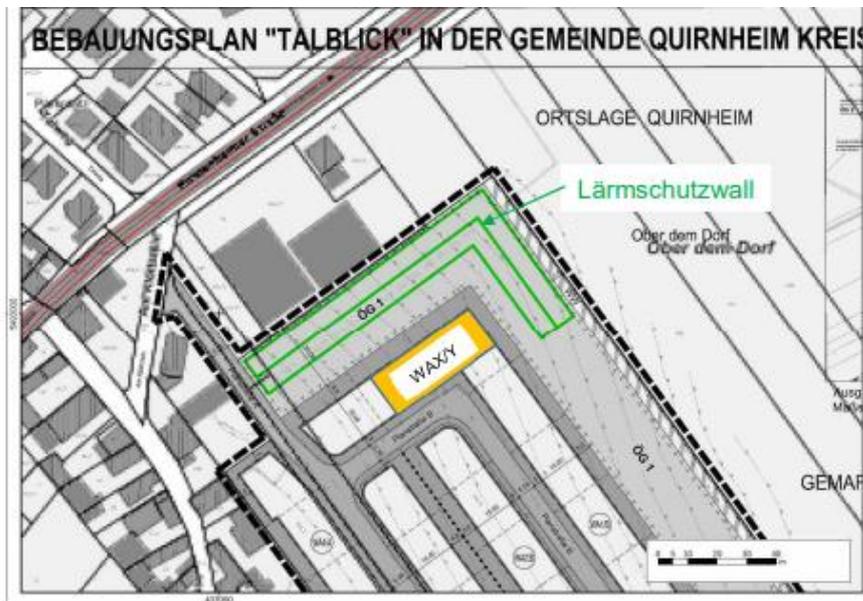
Lageplan der Lärmschutzmaßnahme on IBS, ohne Maßstab
